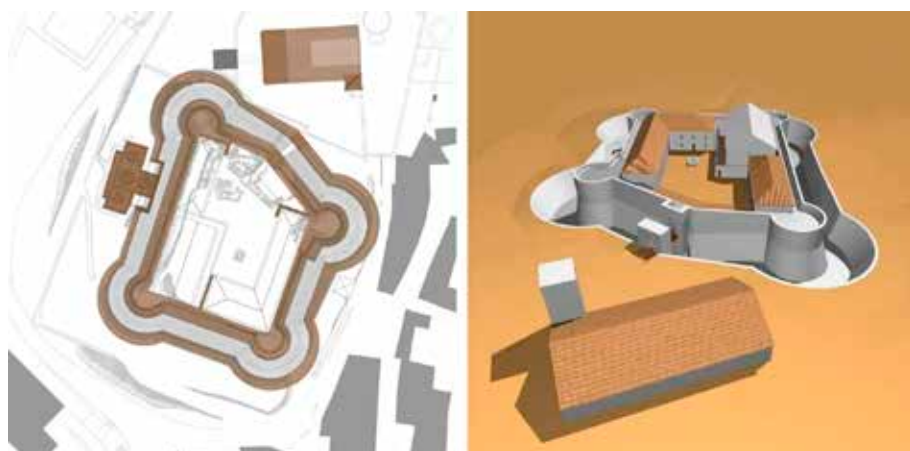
(dupla). Planta do Forte moderno da primeira metade do séc. XVIII sobreposta ao levantamento topográfico actual e, no lado direito, a reconstituição 3D conjectural
